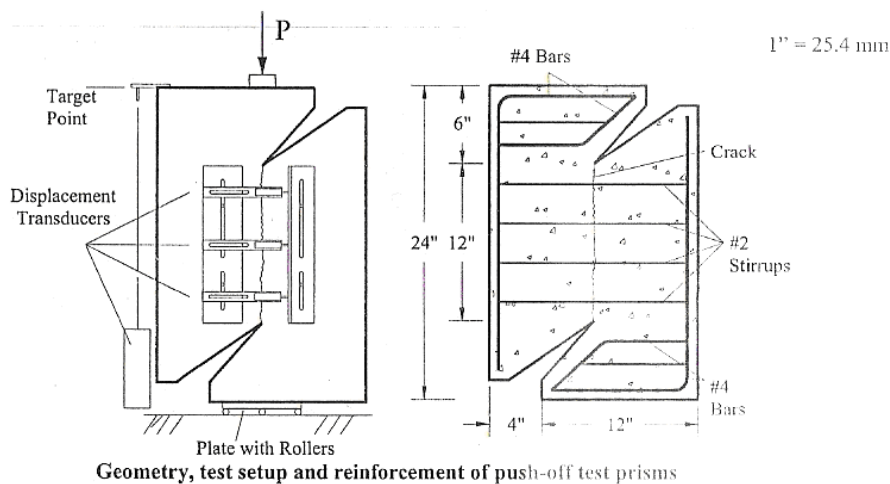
Geometría de las probetas armadas empleadas en los ensayos.
